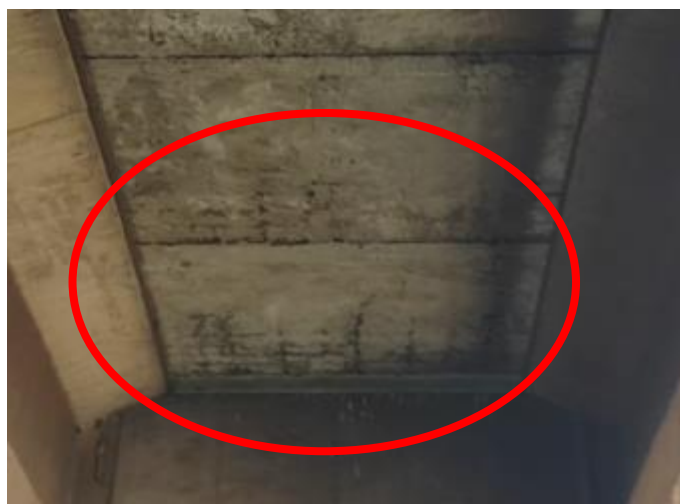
Concreto Segregado Superficial na Laje da Ponte de Acesso
